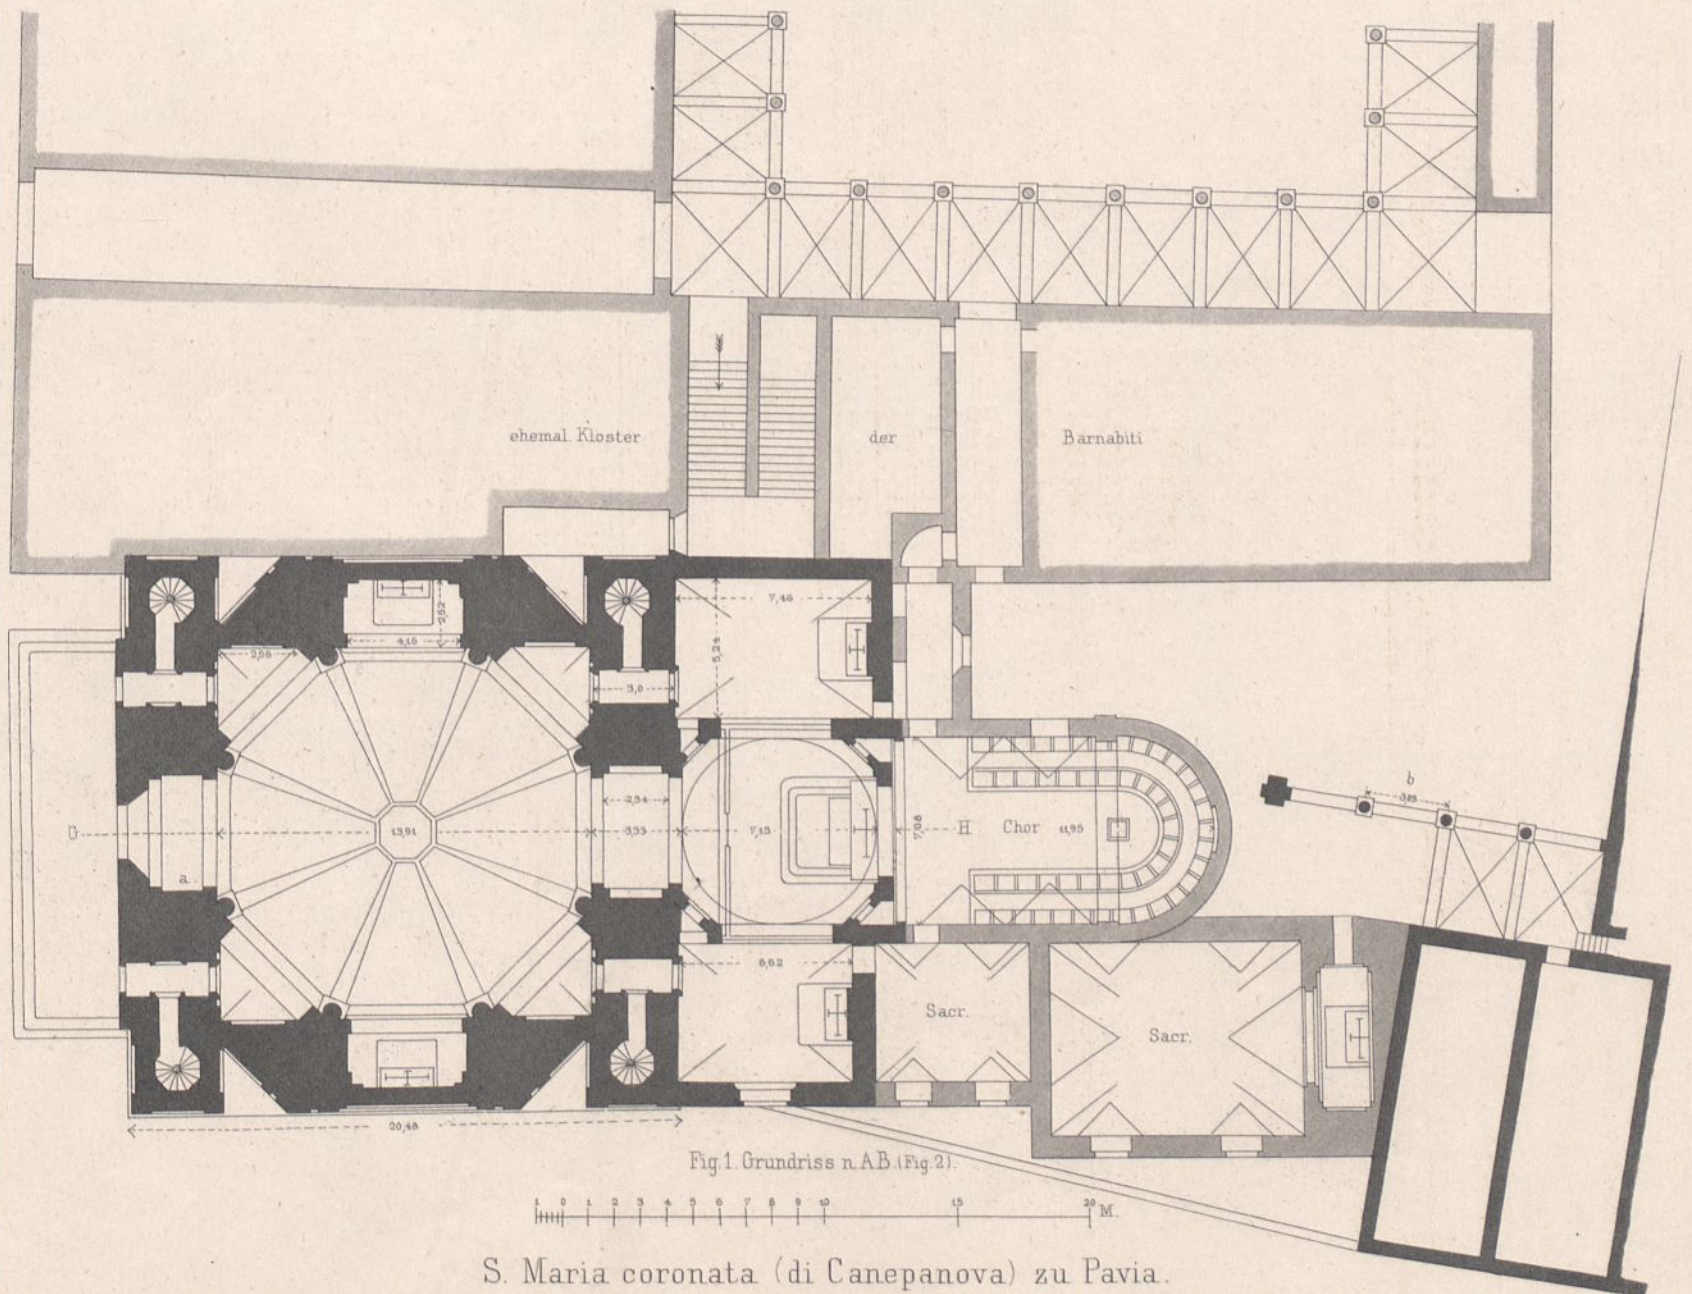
Grundriss n. AB (Fig. 2).
